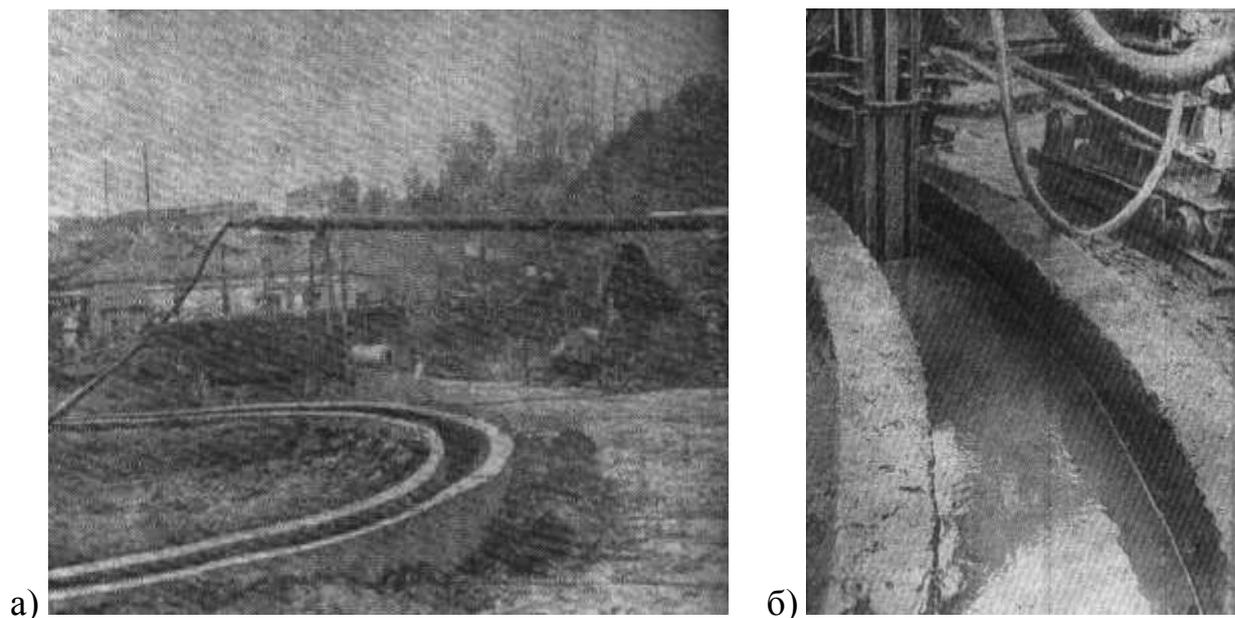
а) - бетонная форшахта для круглого в плане подземного сооружения;
